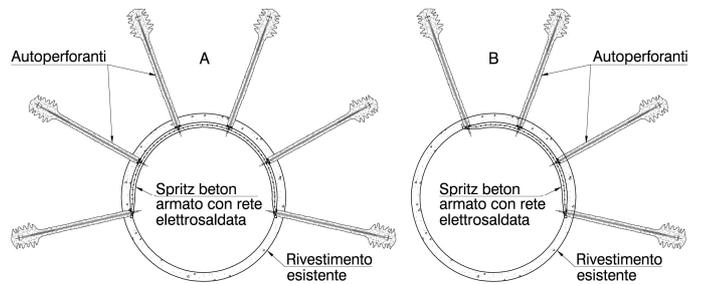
a) La sezione standard che interessa completamente calotta e piedritti – b) Una sezione modificata
